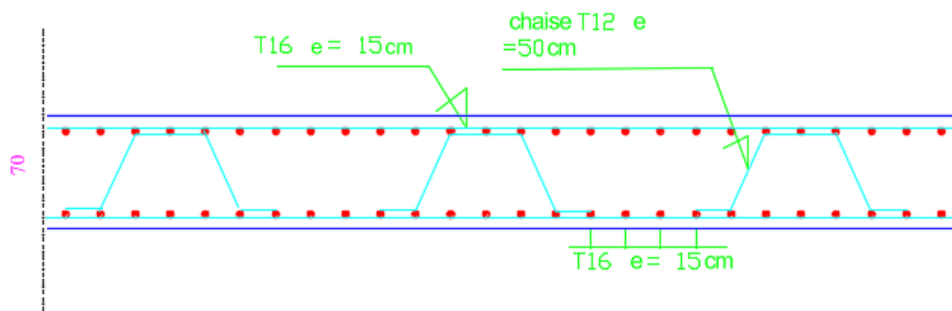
Ferrailage de la dalle du radier sur travée
